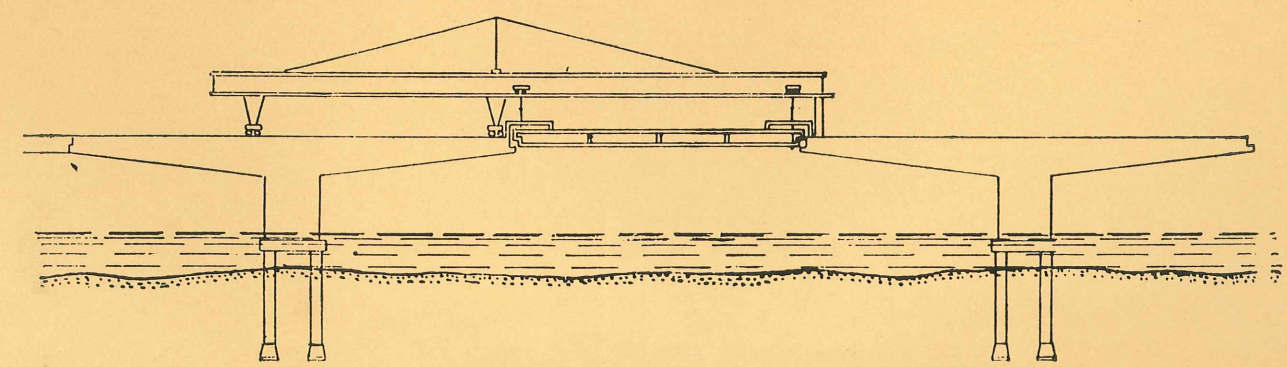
Esquema de la colocación de una de las vigas pretensadas que cierran el vano entre ménsulas
